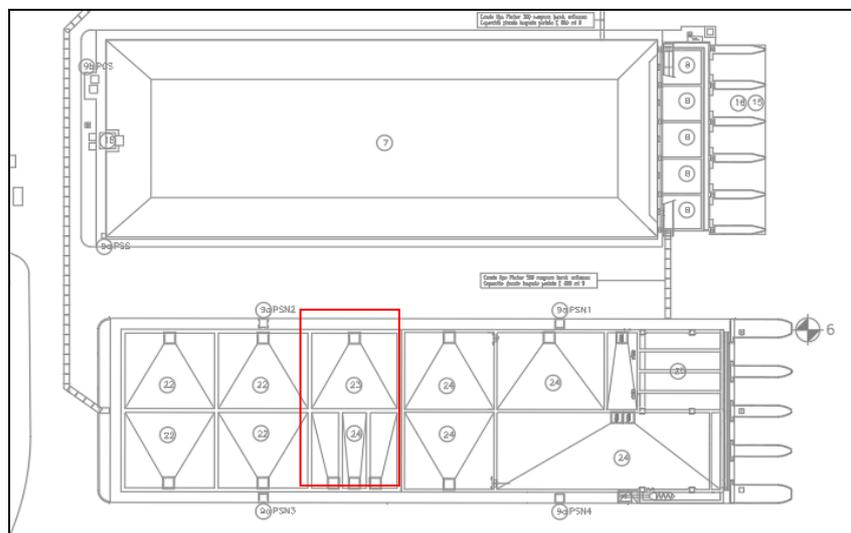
Stralcio planimetria depositi e stoccaggi con indicazione (in rosso) delle vasche di emergenza VE2 (23) e VE1 (24 – suddivisa in tre setti)
